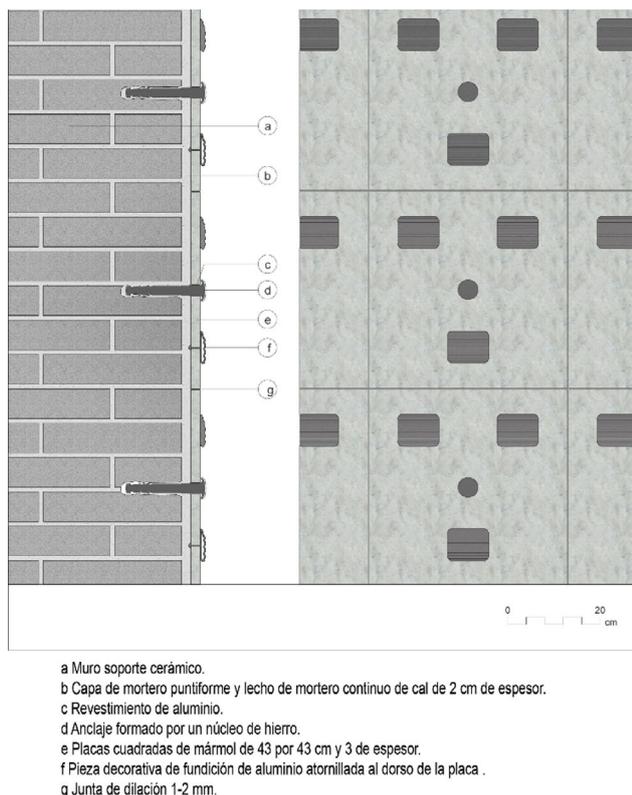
Detalle constructivo despiece central Postsparkasse (Gallego-Blázquez, R.).
